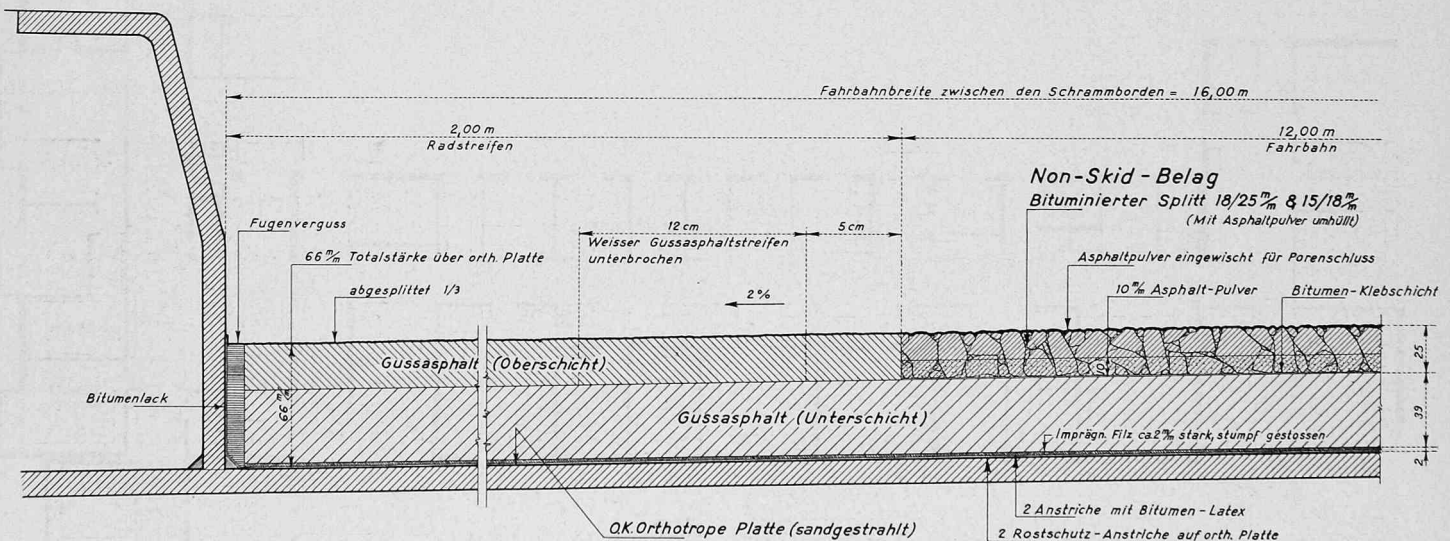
Aufbau des ursprünglichen Fahrbahnbelages auf der St.-Alban-Brücke, Massstab 1:4
